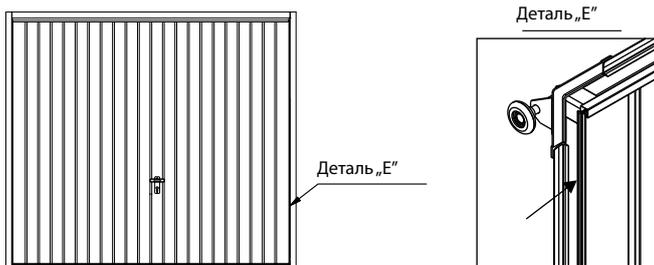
Подъёмно-поворотные ворота, оборудованные боковыми релингами - вид с наружной стороны.
